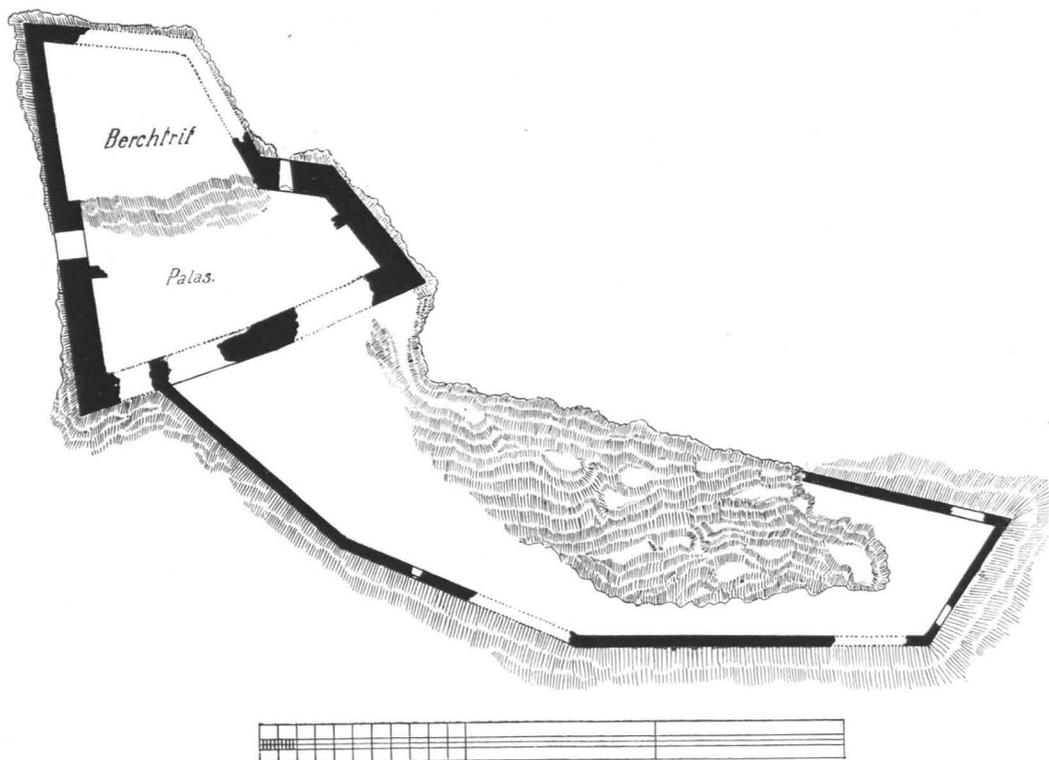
Ruine Wartenfels, Grundriß 1 : 400 (S. 248)
